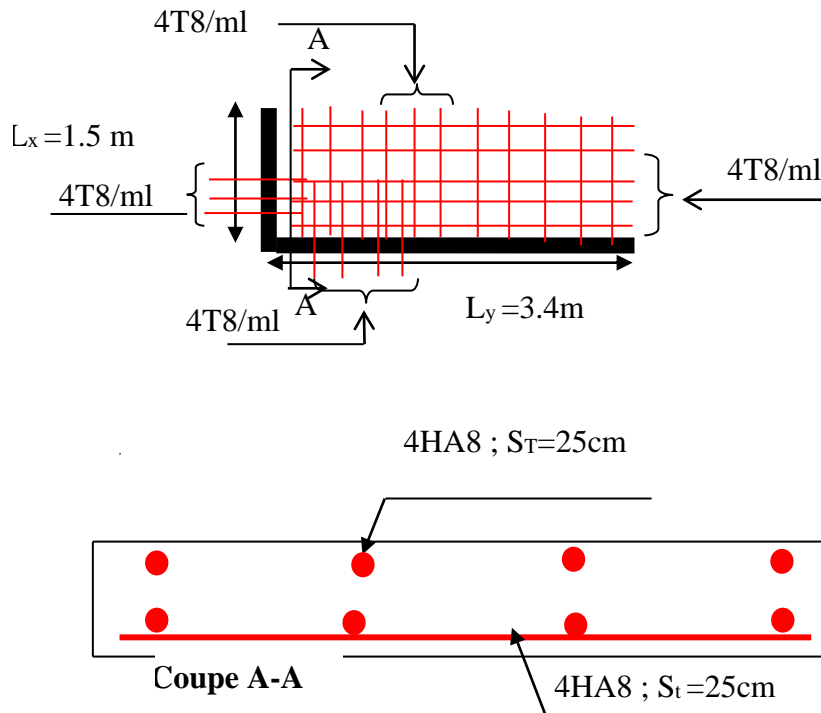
Schéma de ferrailage de la dalle sur deux appuis
